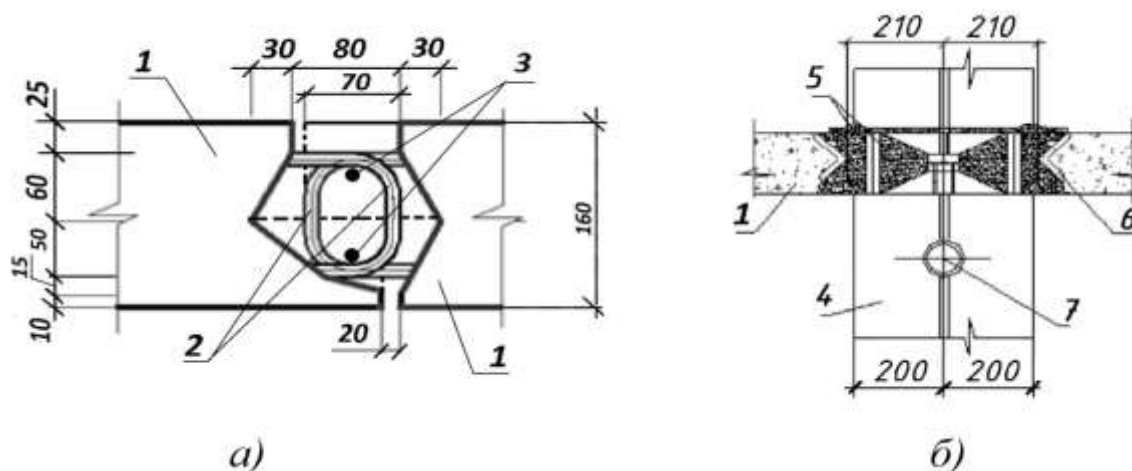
Конструкції вузлів з'єднання: а) – плит перекриття між собою; б) – надколонної плити з колоною; 1 – плита; 2 – петльові випуски арматури; 3 – монтажна арматура; 4 – колона; 5 – бетонна шпонка; 6 – сталеве обрамлення отвору в плиті; 7 – отвір для установлення пристосування для монтажу плити
